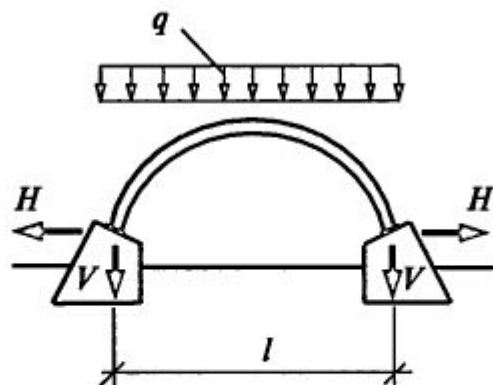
Передача нагрузки от арки на фундаменты:
